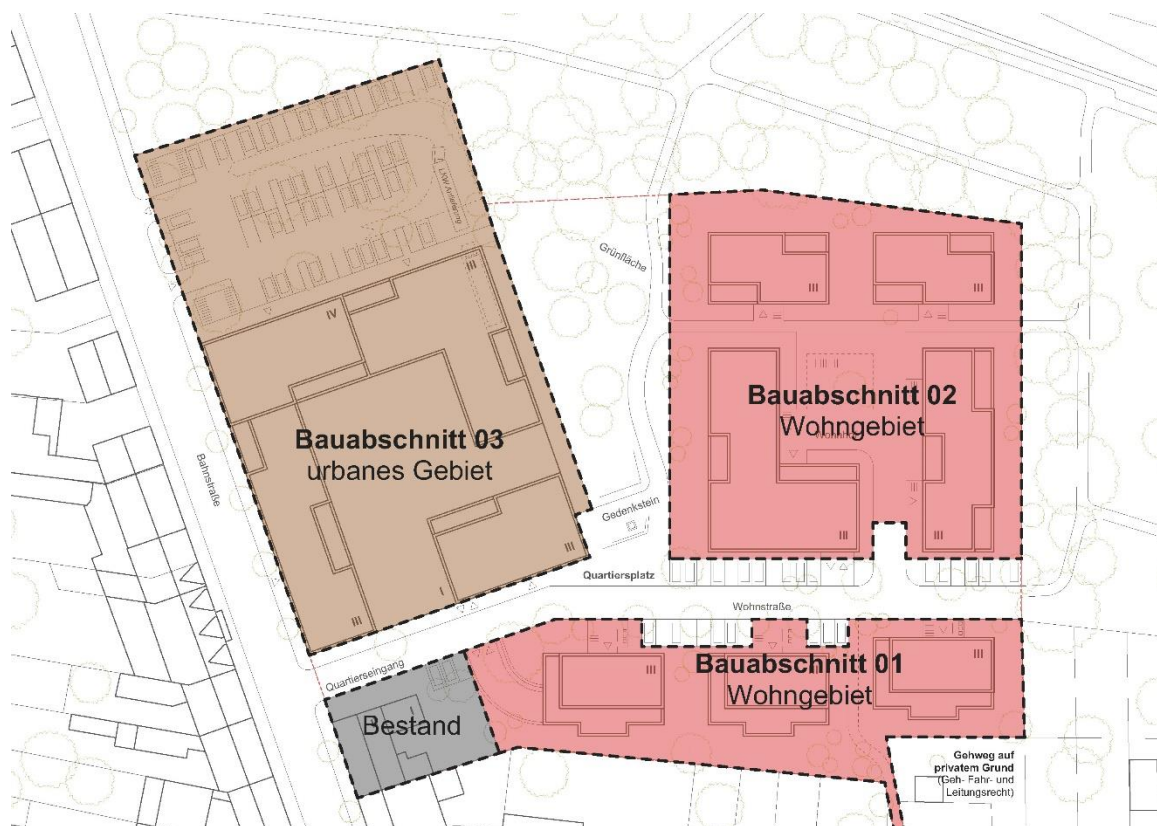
Rahmenplanung | Bauabschnitte und -zuschnitte © LECKE ARCHITEKTEN
